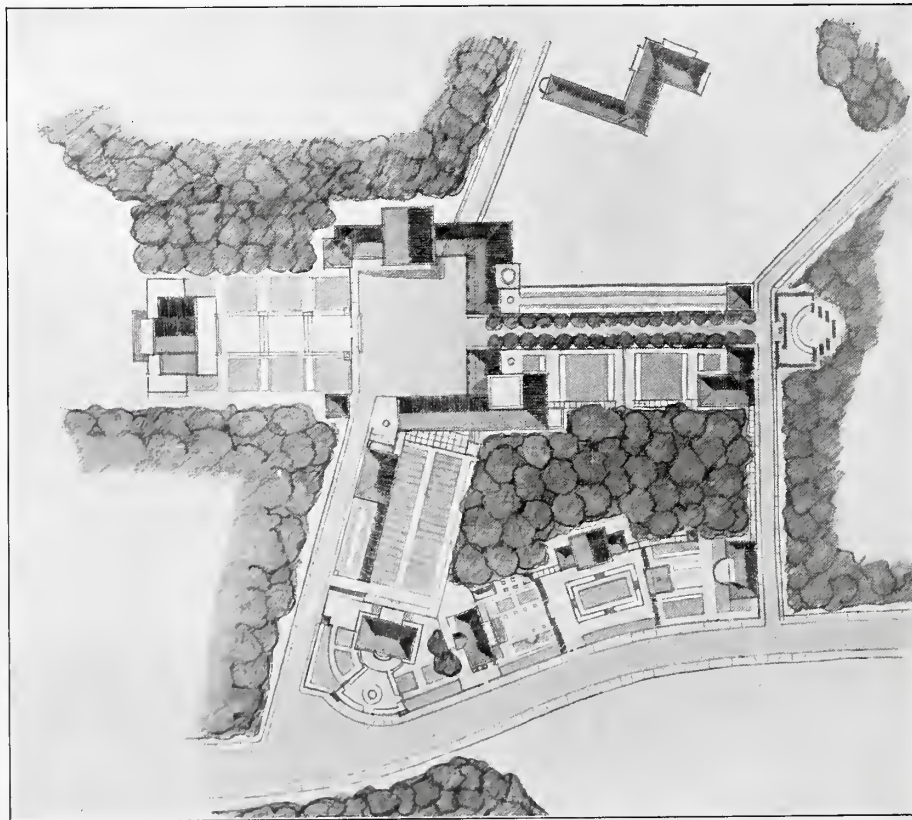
Peter Behrens: Lageplan der projektierten Villenkolonie in Eppenhäusen.
